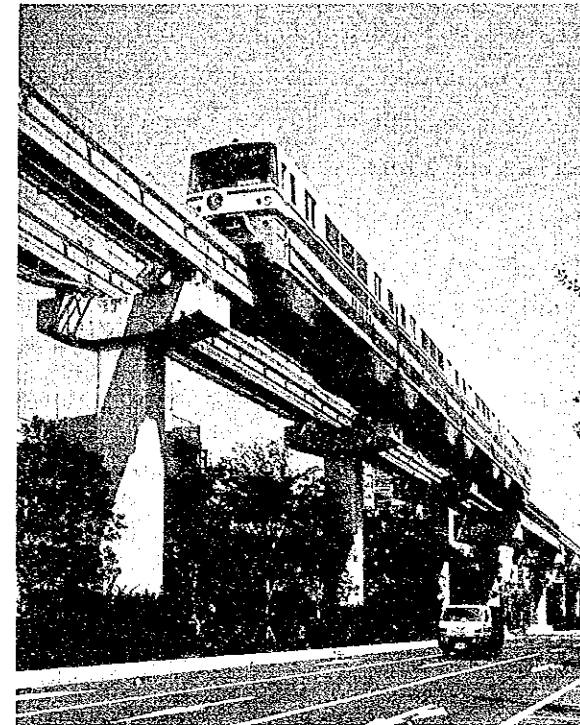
Aspect extérieur du monorail à cheval sur poutre
